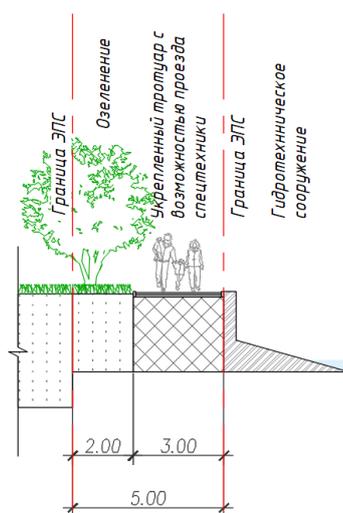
Разработанный проектом поперечный профиль пешеходной набережной
